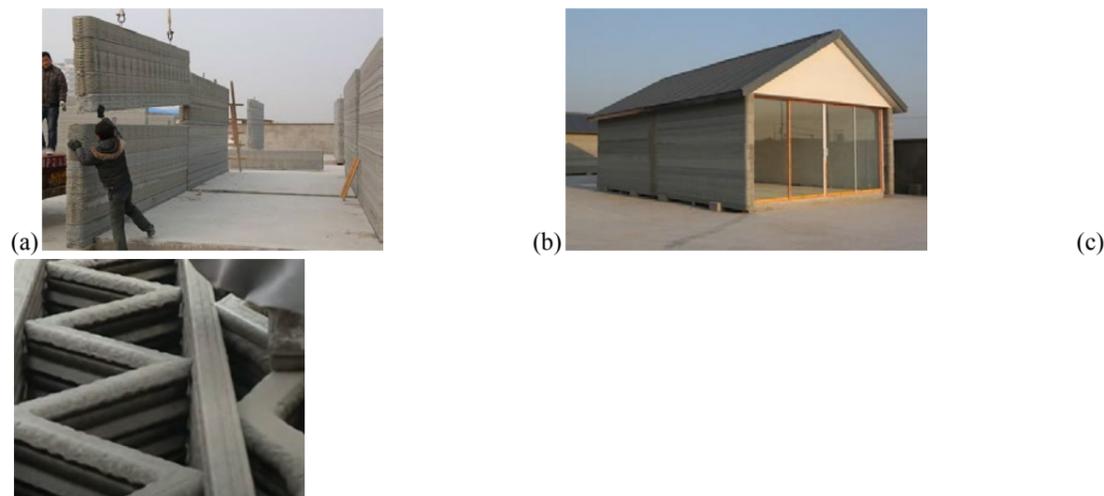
(a) Montagem de parede, (b) casa finalizada e (c) estrutura do elemento pré-fabricado. Fonte: Walker (2014).
